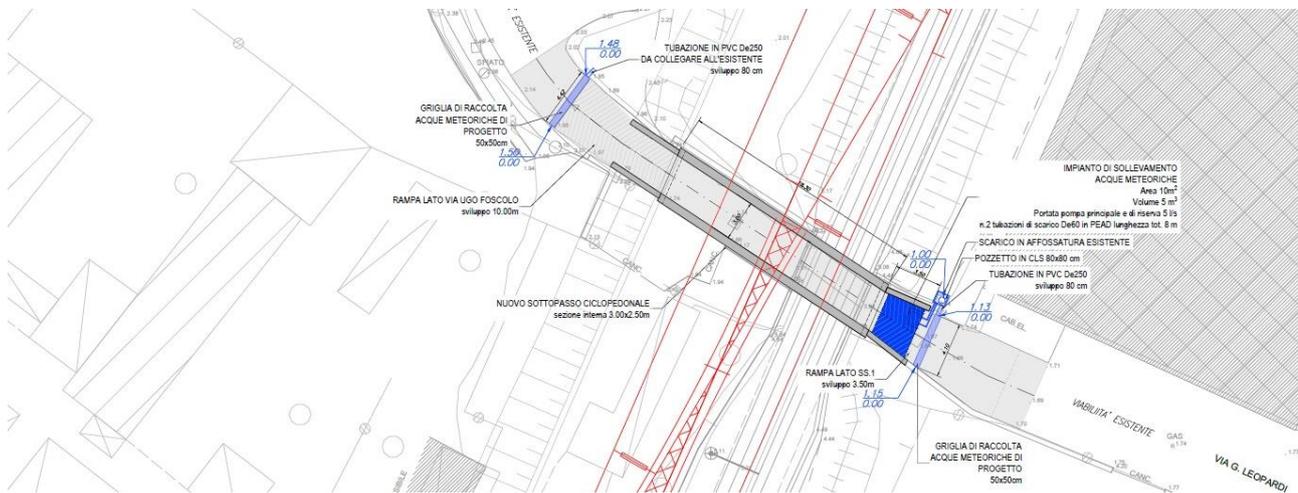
SL02 - Pianta smaltimento idraulico della piattaforma stradale
